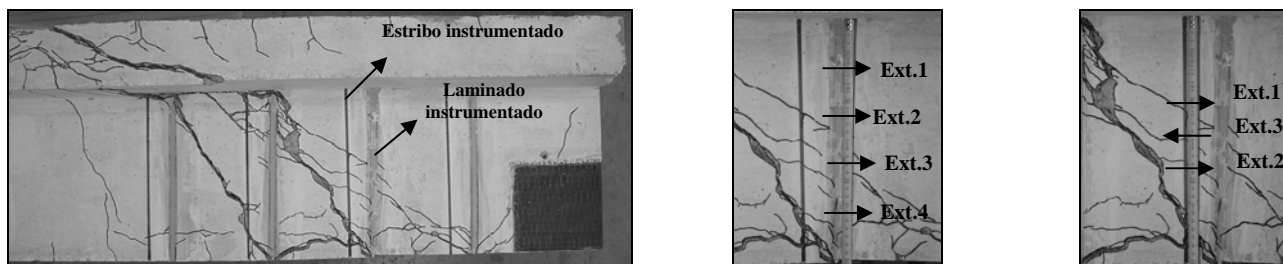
Localização dos extensômetros no laminado e estribo instrumentados da viga 4S-4LV-B.
